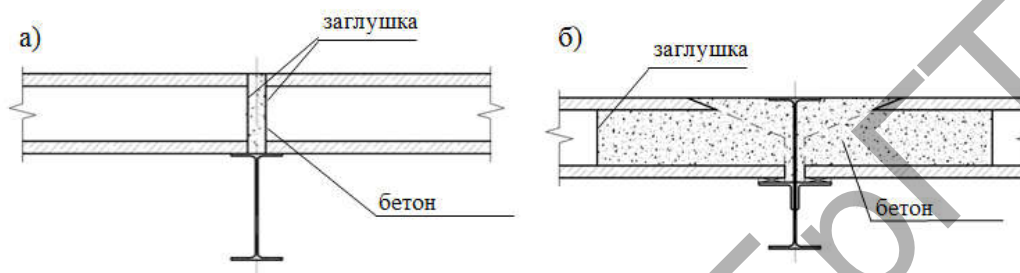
Узел опирания сборной железобетонной плиты на средний ригель:
